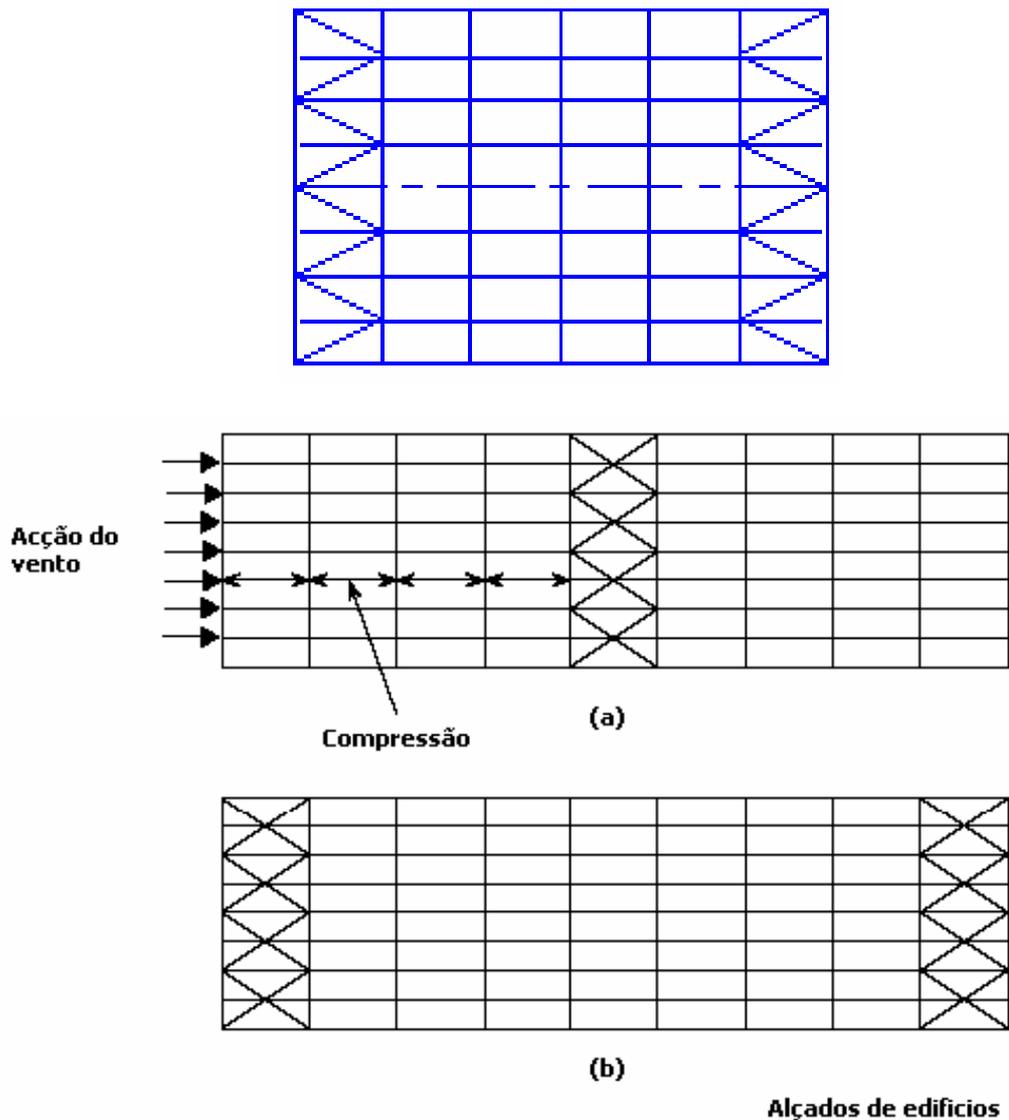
Esquema correcto de introdução de contraventamento para as madres só terem tracções
